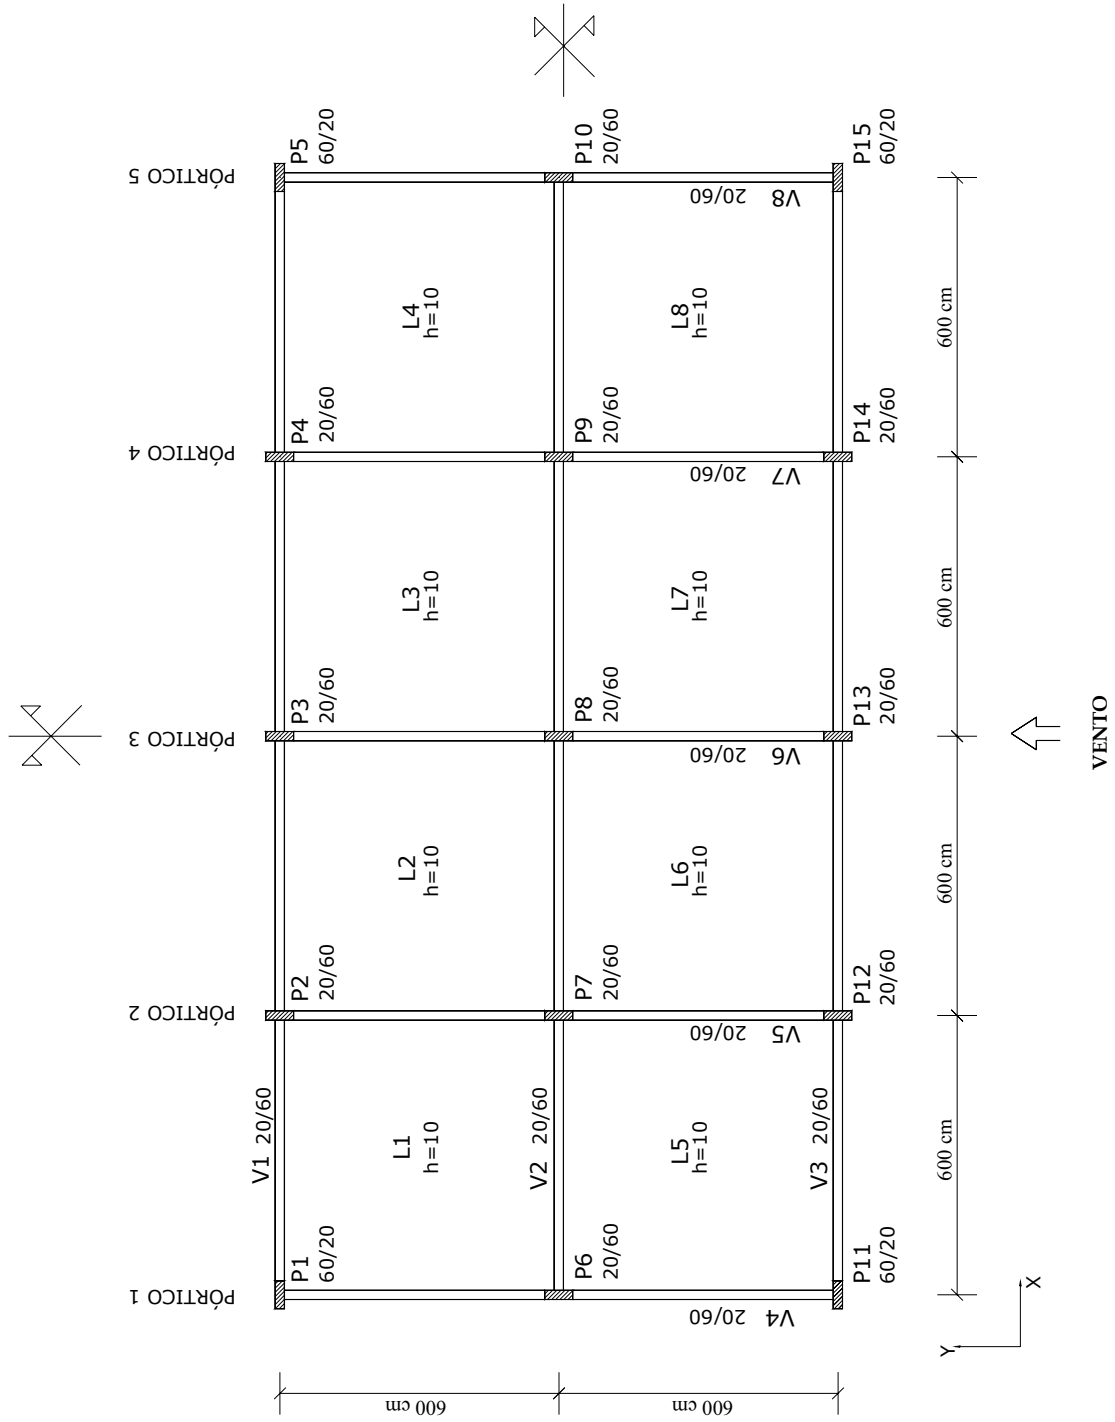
Forma do pavimento tipo da Estrutura 1.
